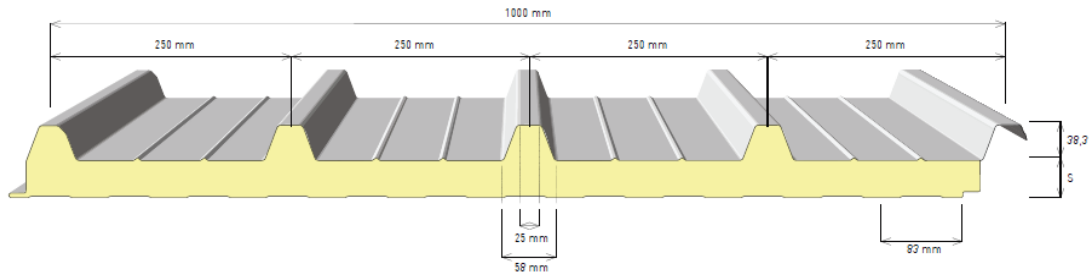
Painel Irmamenta de cinco ondas (Tabela Edigespor construção)
